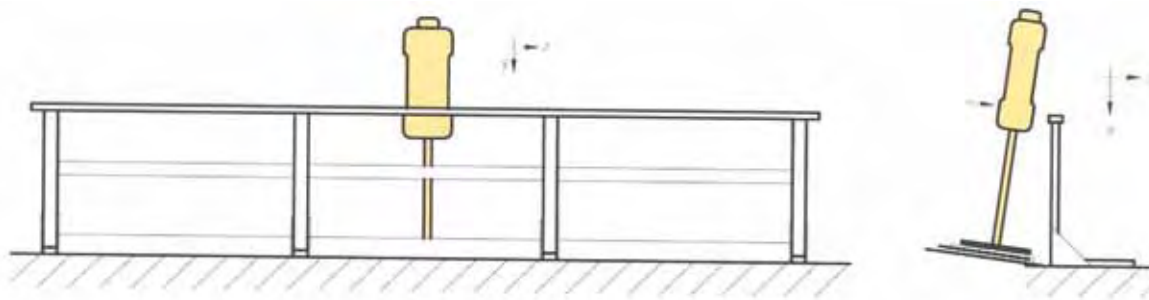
Essais dynamiques sur la lisse supérieure de la section centrale d’une suite de trois travées de garde-corps ancrées au parapet.
